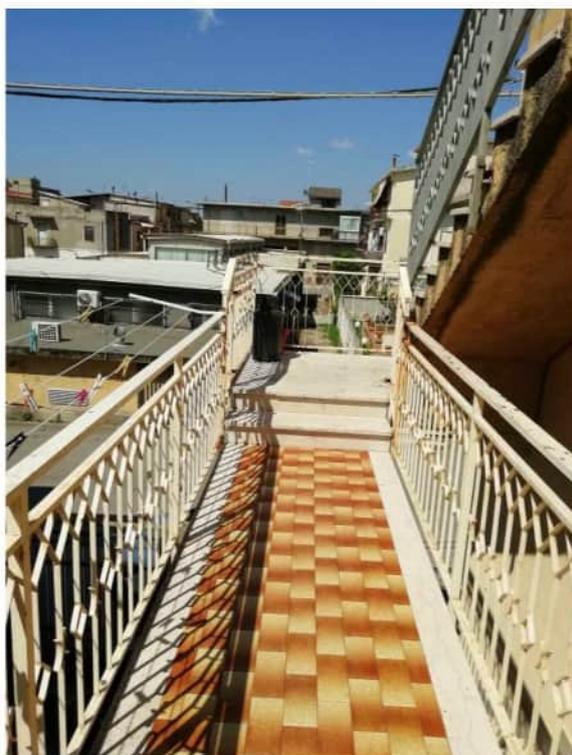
Vista corpo esterno Rampa scale di collegamento piani palazzina
